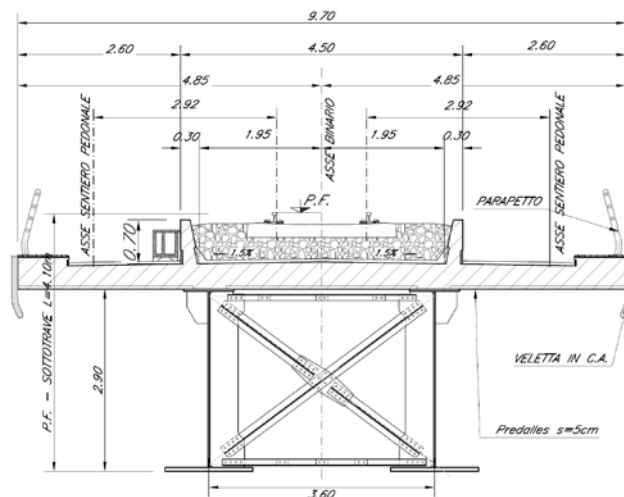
Sezione trasversale campate in acciaio-clc L=40 m
